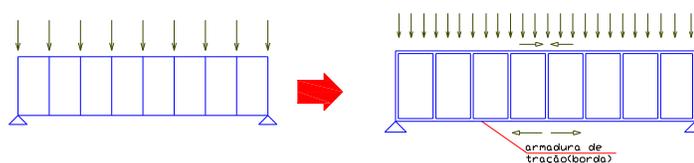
Modelo de viga Vierendeel. Fonte: arquivo do autor
